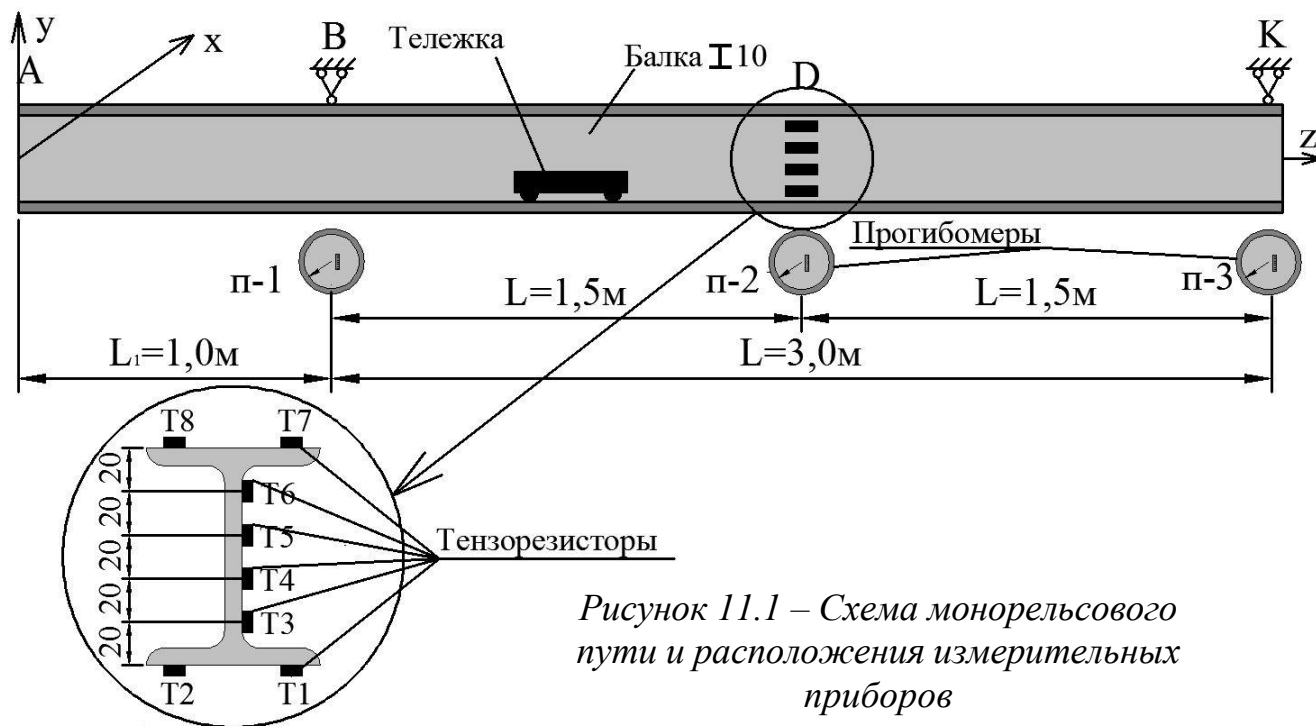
Схема монорельсового пути и расположения измерительных приборов
